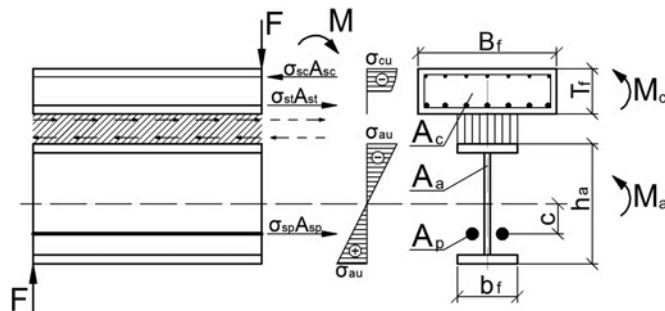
Розподіл внутрішніх зусиль в нормальному перерізі ПНСЗБ балки з верхньою залізобетонною полицею без зчеплення або з частковим зчепленням, що нехтується, при дії зовнішніх зусиль F і M в граничному стані її несучої здатності.
